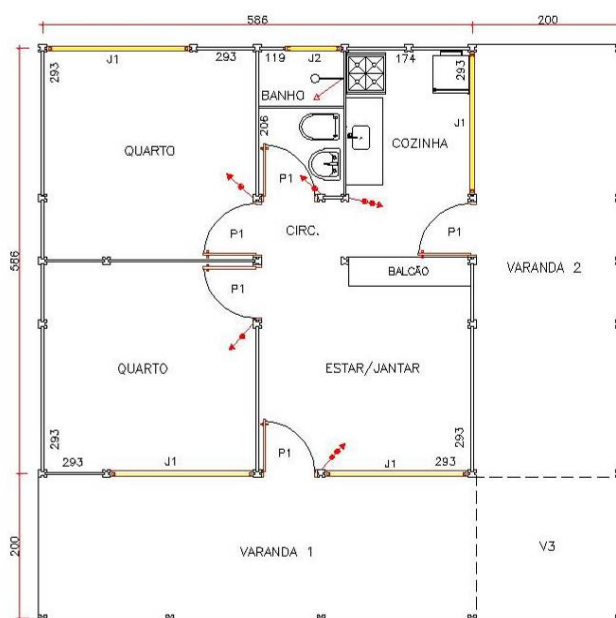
Planta Padrão de Edificação Residencial: 35,64m².
